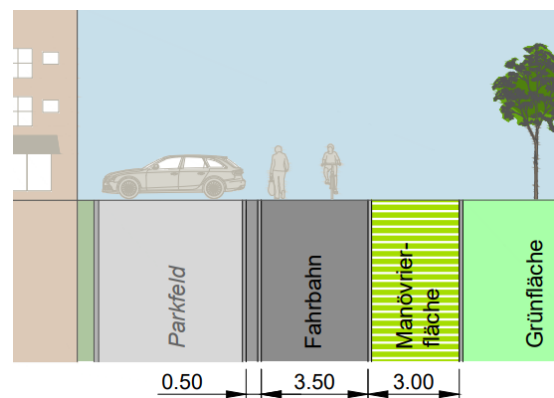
Schemaschnitt Fahrbahneinengung als «Manövrierfläche» für gegenüberliegende Parkierung
